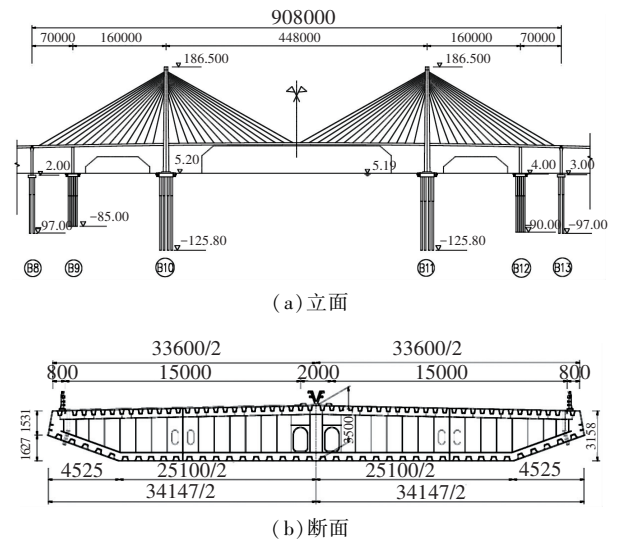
桥梁结构布置图(尺寸单位:mm;标高单位:m)
